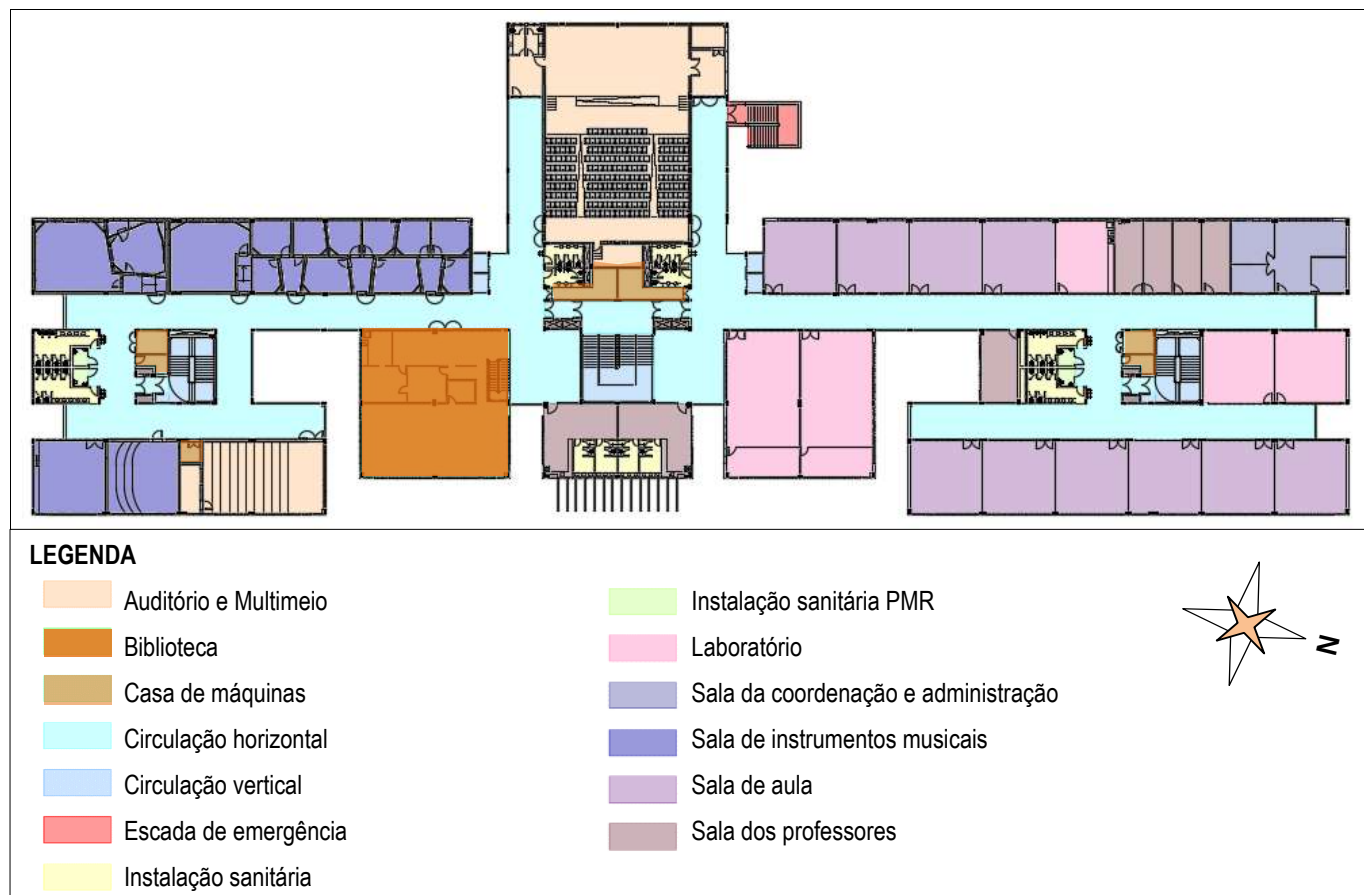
Planta setorialização do primeiro pavimento do bloco 07.
